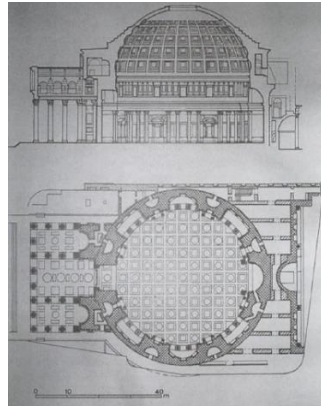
Panteón Sección y planta. Fuente: Gallegos, Héctor y Casabonne, Carlos, Albañilería Estructural (2005).
